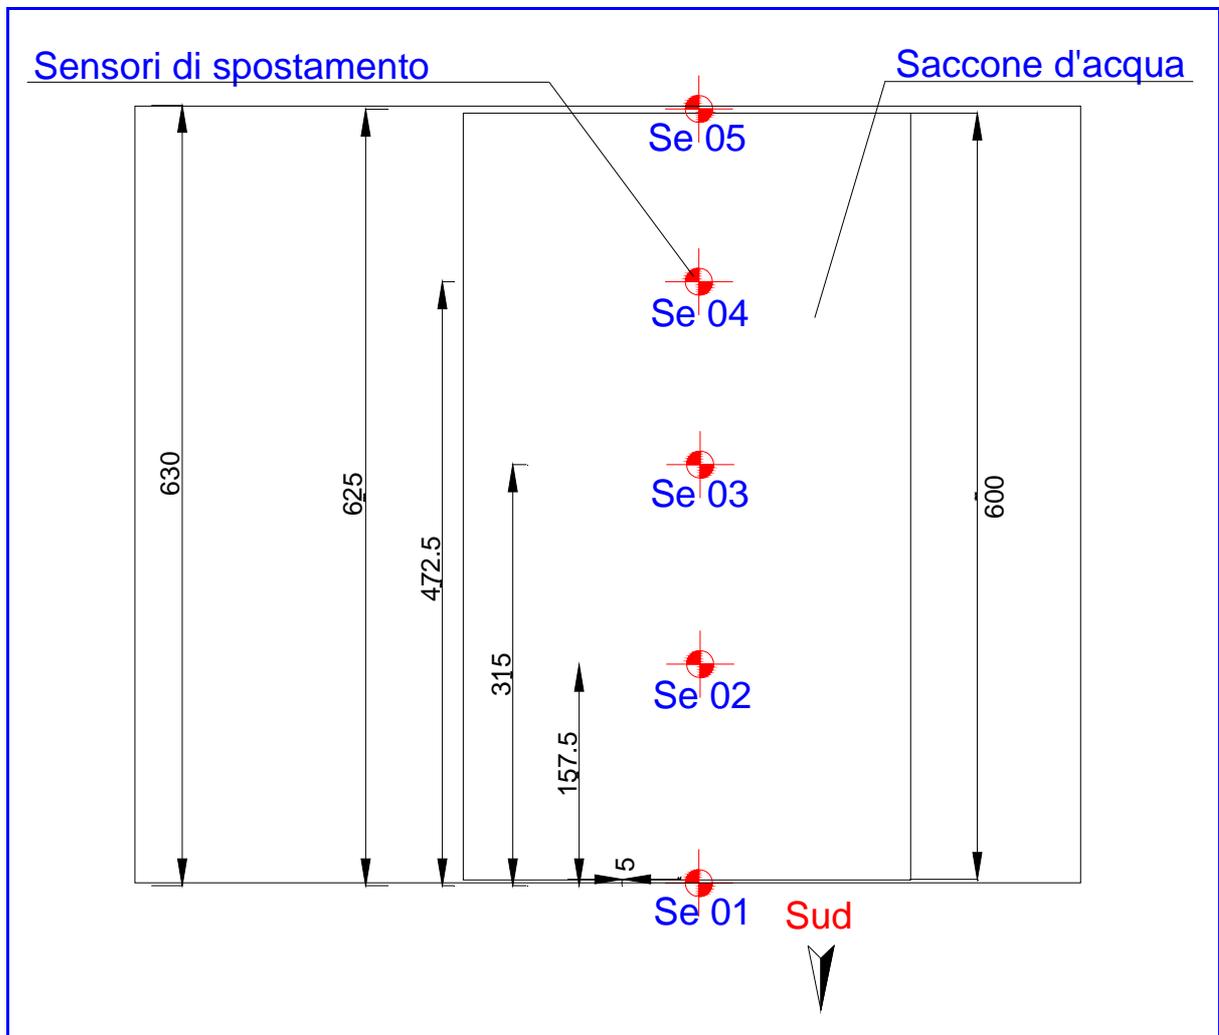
Disposizione in pianta dei Sensori di spostamento e del saccone d'acqua.
